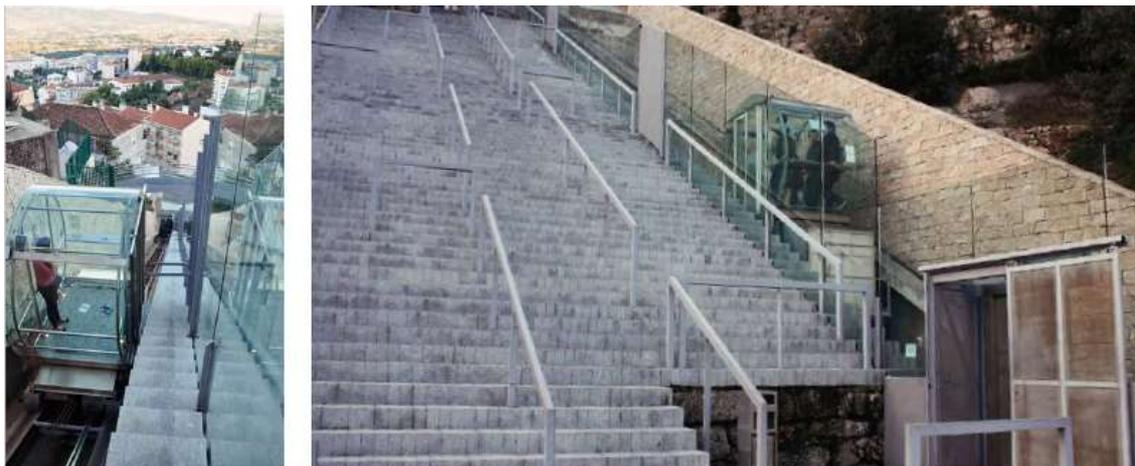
Sistema de elevación tipo “plano inclinado” de Covilhã, Portugal.
